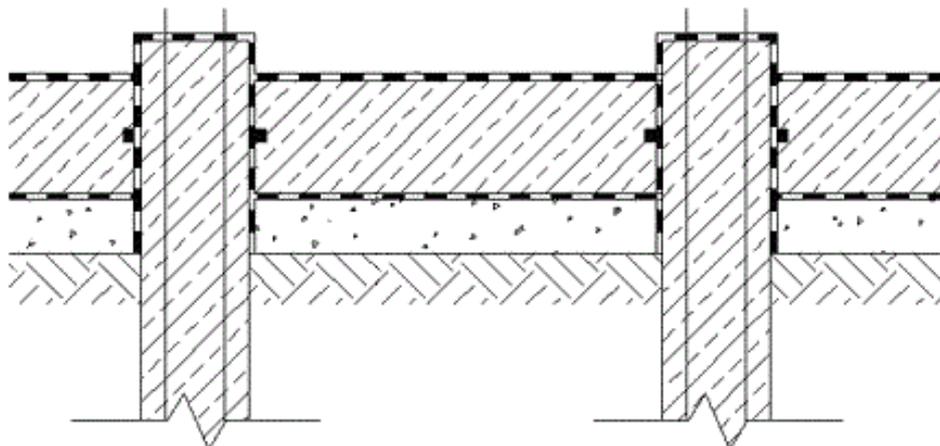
Proposta de impermeabilização de um encabeçamento de estaca [w₅₇]
